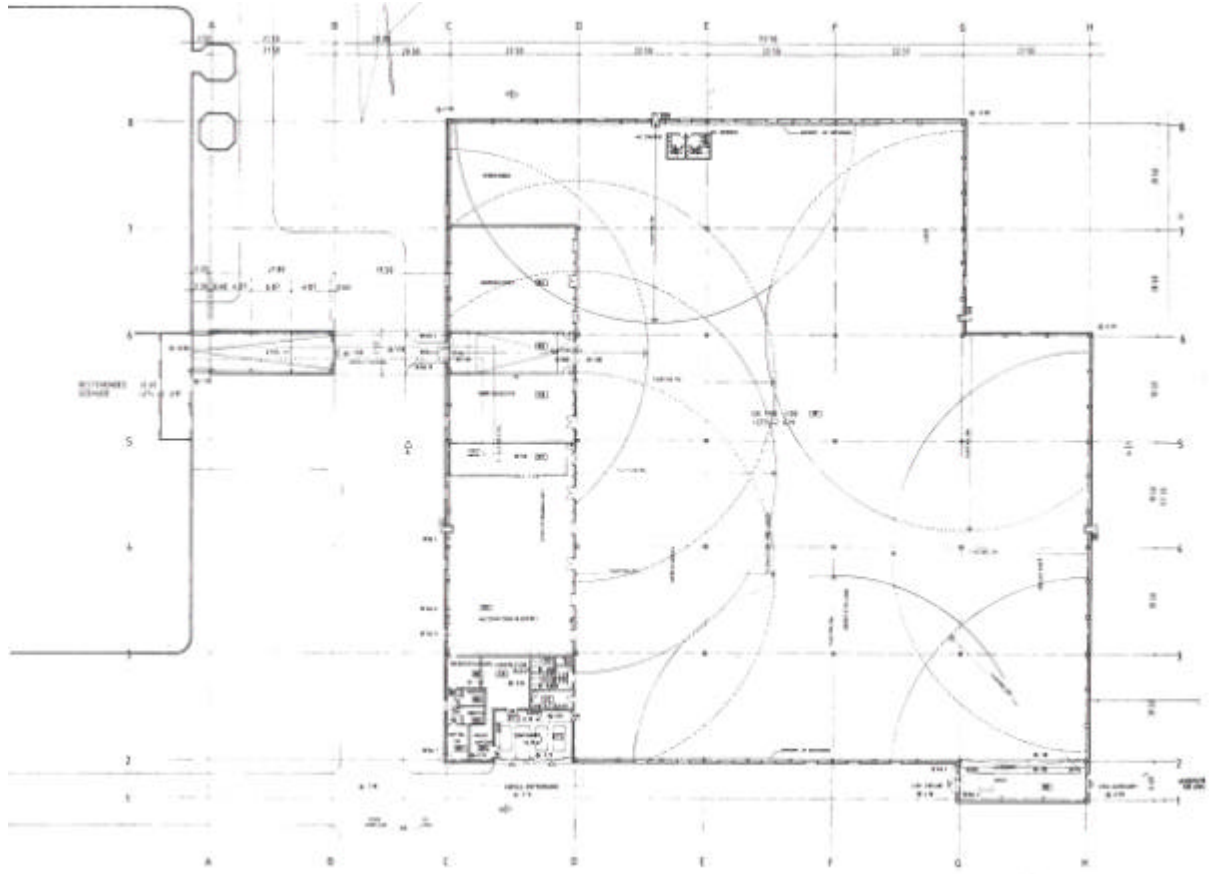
Alvaro Siza, VitraShop-Halle, 1991-1994, Grundriß
